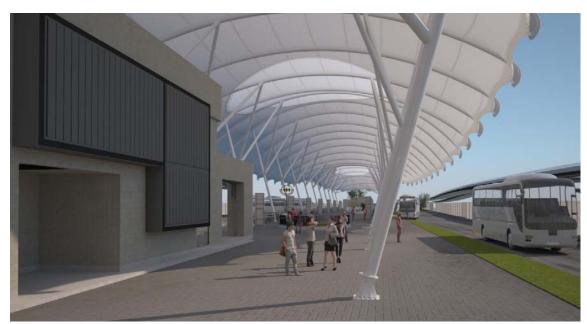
Vista Referencial Interior Estructura de Cubierta EIM Los Libertadores – Plataforma de Buses Urbanos
